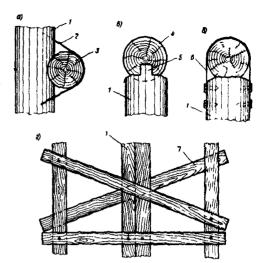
Установка деревянных элементов а — сопряжение схватки со сваями на скобах; б — сопряжение насадки со сваями на шипах; в — сопряжение насадки со сваями с помощью хомутов; г — раскосы из пластин; 1 — сваи; 2 — скоба; 3 — схватка; 4 — насадка, 5 — шип; 6 — хомут; 7 — раскосы
